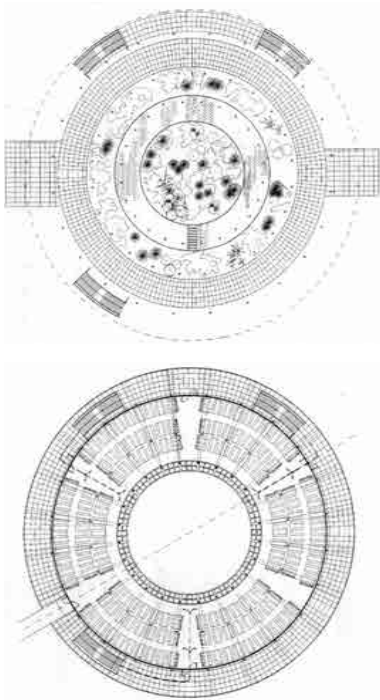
y Fig. 24 Comedores circulares del Centro de Cheste. Planta baja (arriba) y planta alta (abajo).
